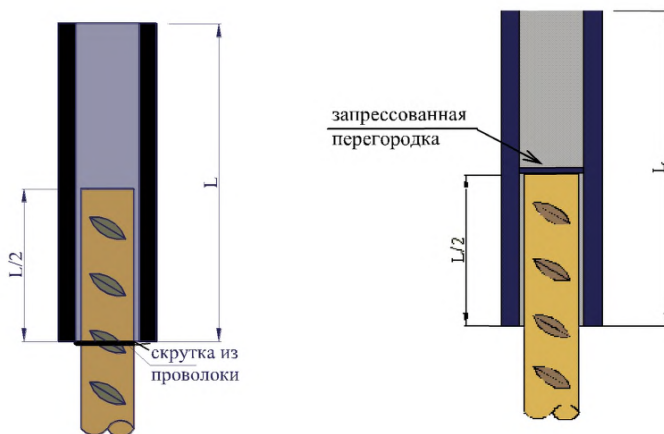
Центровка стыка с помощью скрутки или запрессованной перегородки
